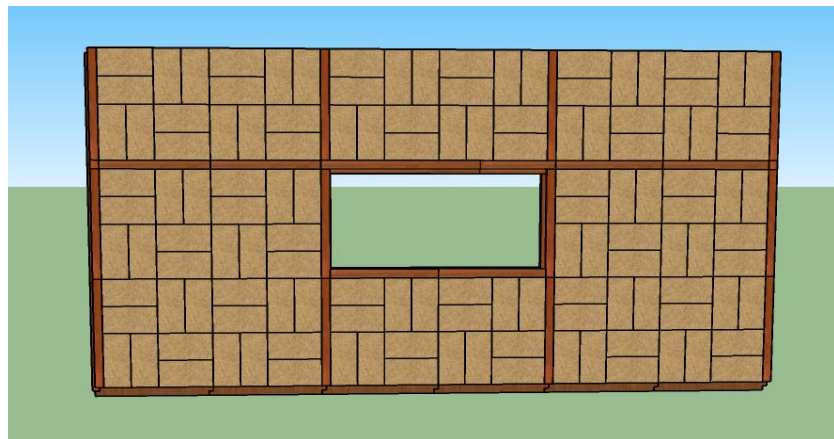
Parede com peças de 25 x 50 x 12 cm e estruturas de madeiras para a sustentação e conexão com as outras paredes da habitação.
